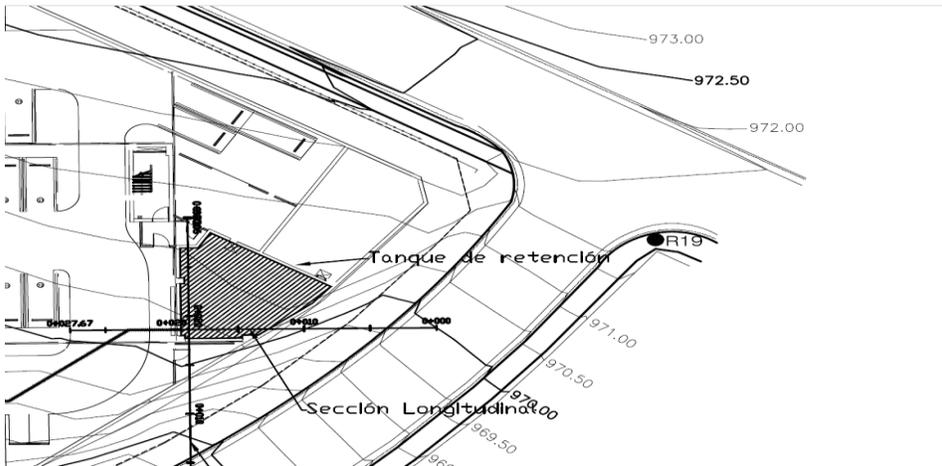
Ubicación de Sistema de Retención Pluvial, área de sótanos. lámina # PLSA-01 de los planos presentados.
